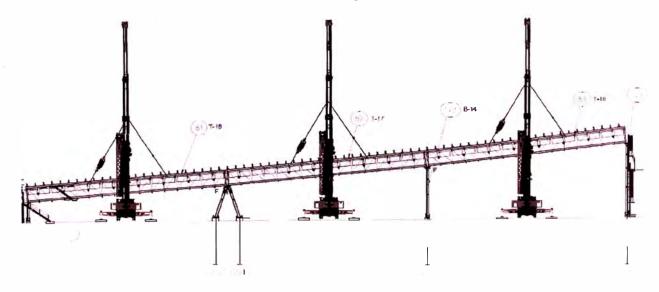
Secuencia de montaje de los truses B-16 al B-18
